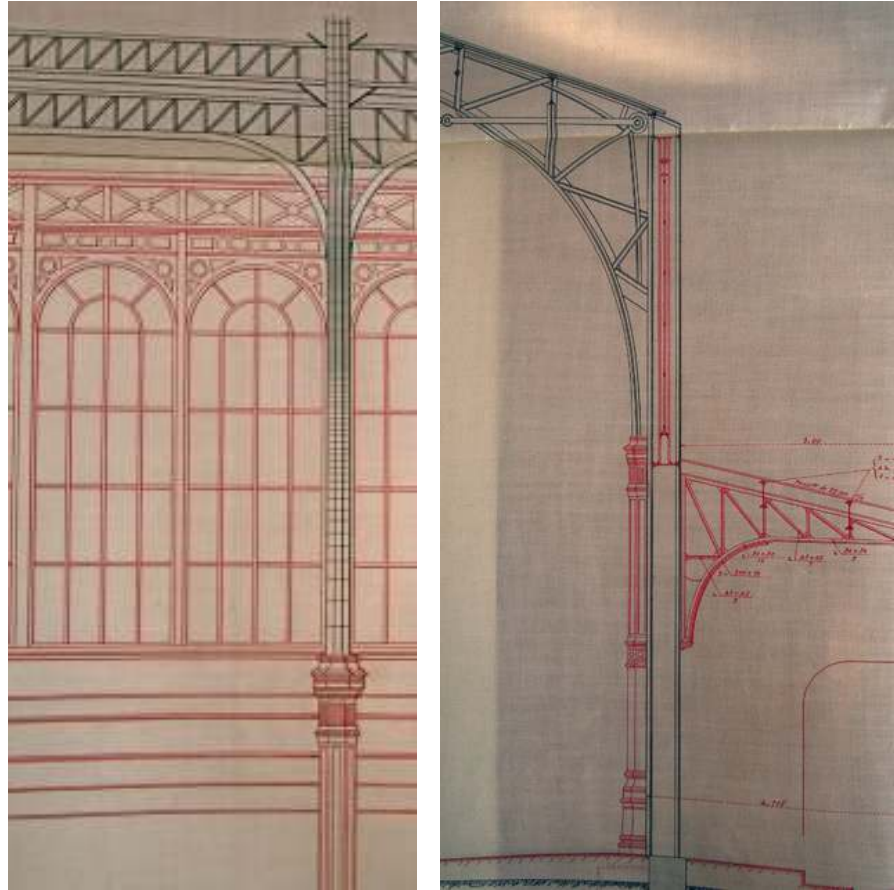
y 113.- Detalle de cristalería. Alzado y sección. E. de P. Pío. (FFE - 2010).
